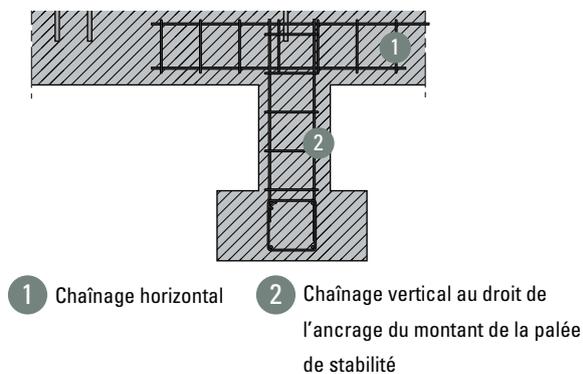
Exemple d'assemblage entre structure légère et fondations (2)
